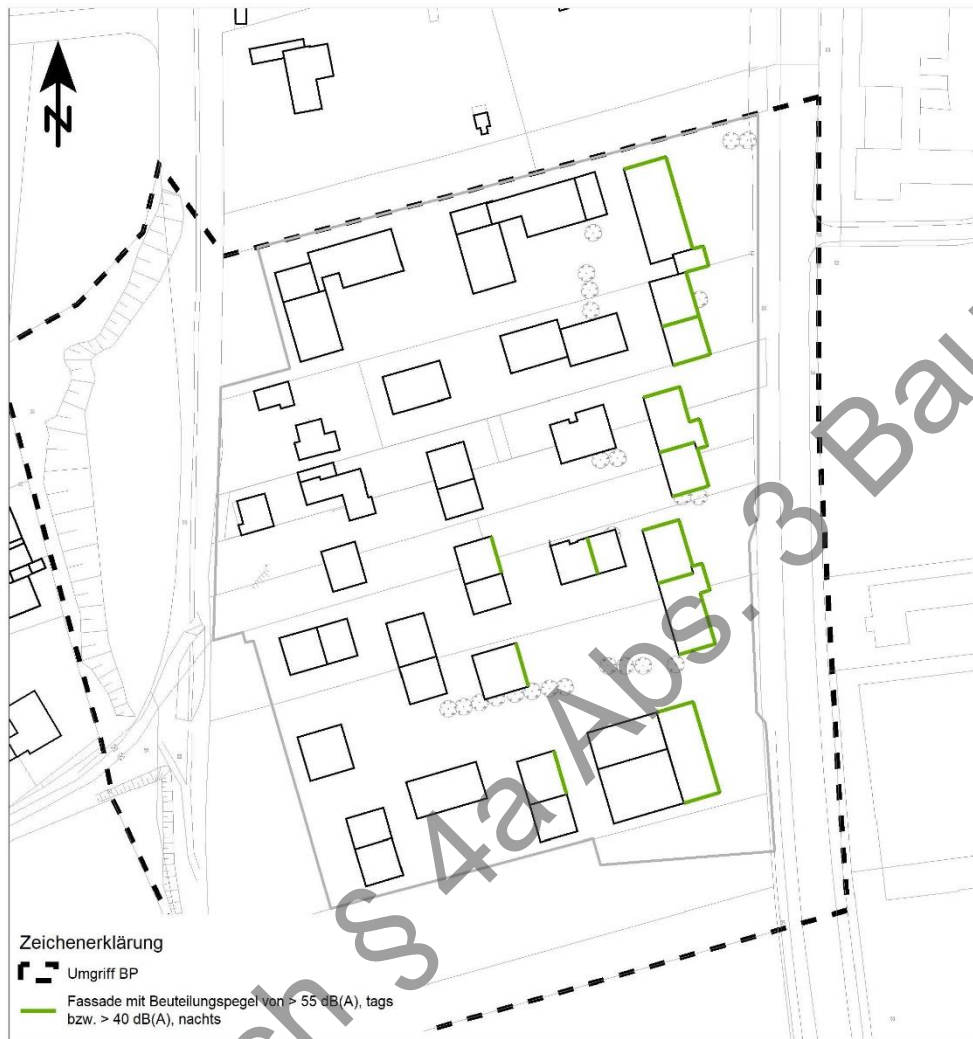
Lageplan betroffene Fassaden Gewerbelärm
